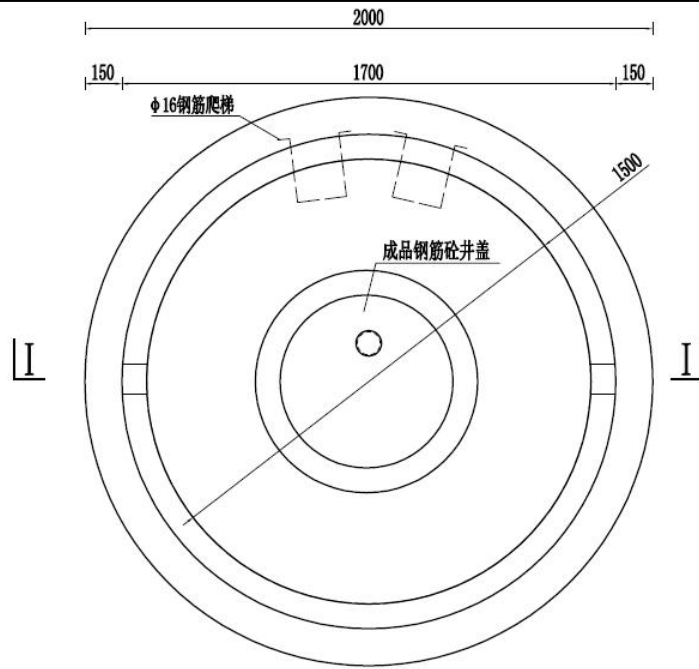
控制阀井、排气补气阀井、排水井平面图（单位：mm）
